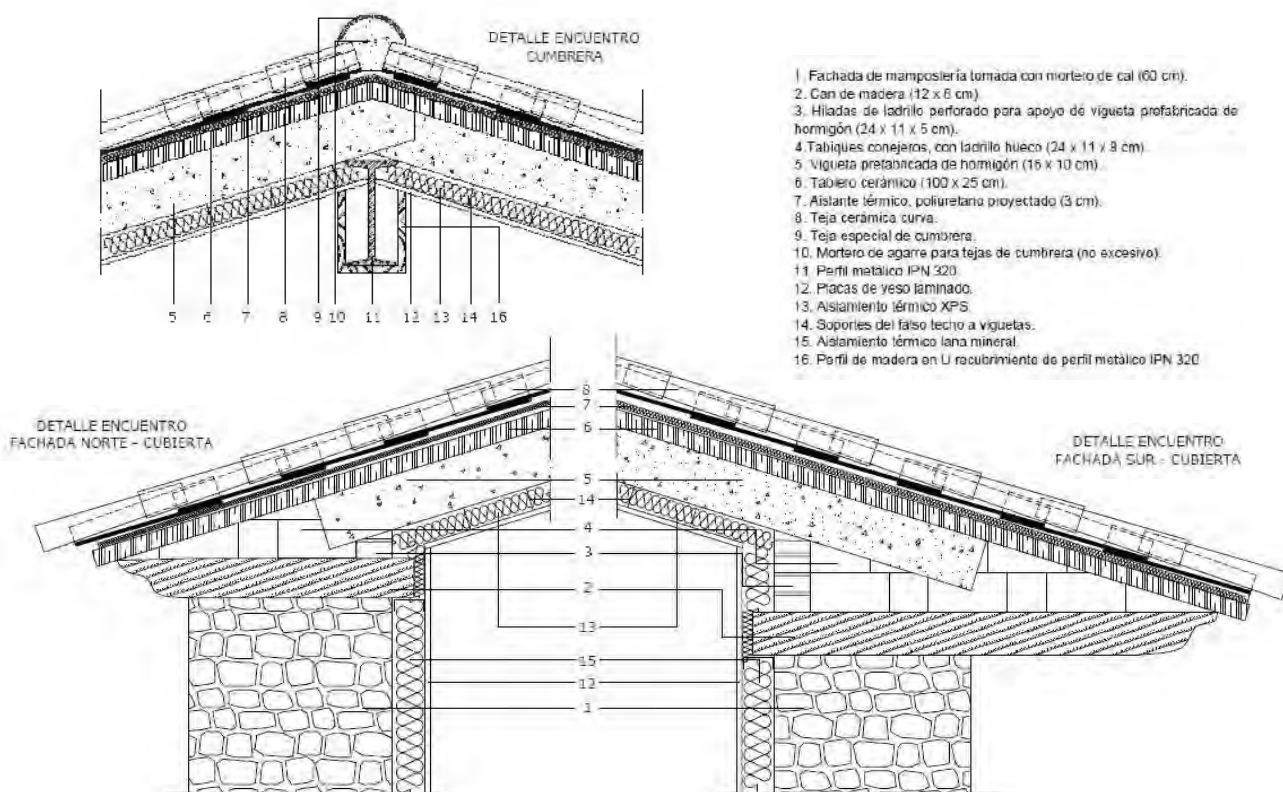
Detalles constructivos cubierta estado reformado. Fuente: propia.
